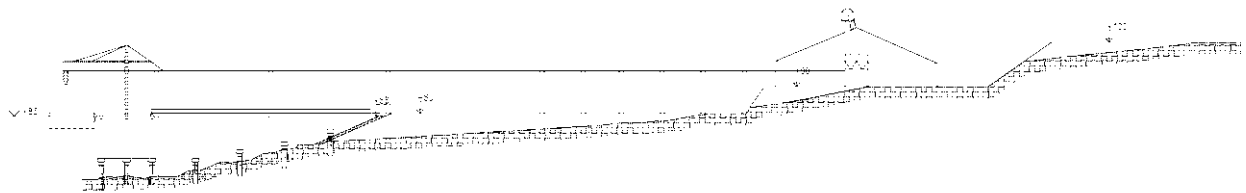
Plano de la Sección Transversal de las Instalaciones
